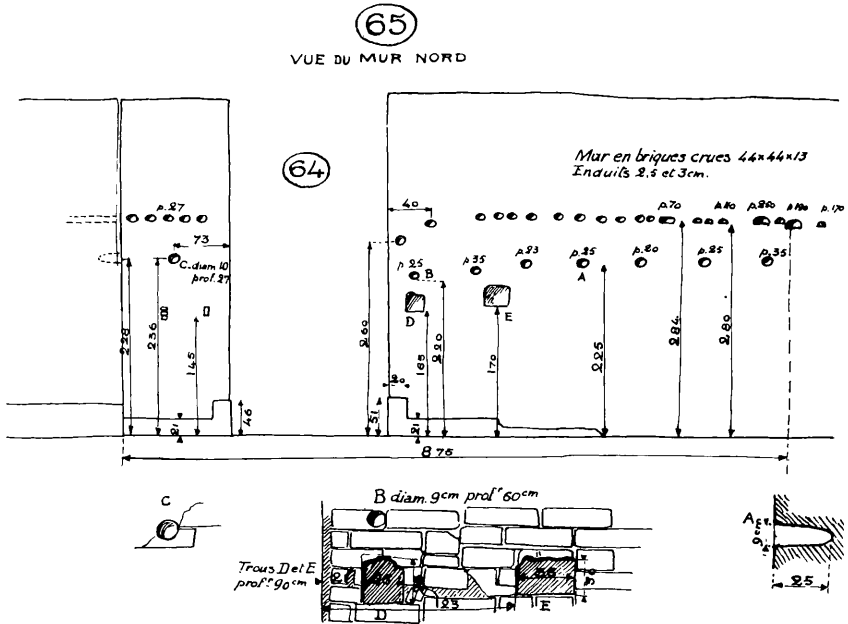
Salle du trône 65. Élévation du mur nord.
